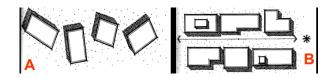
13. Massa Bangunan Ruang yang Mati
